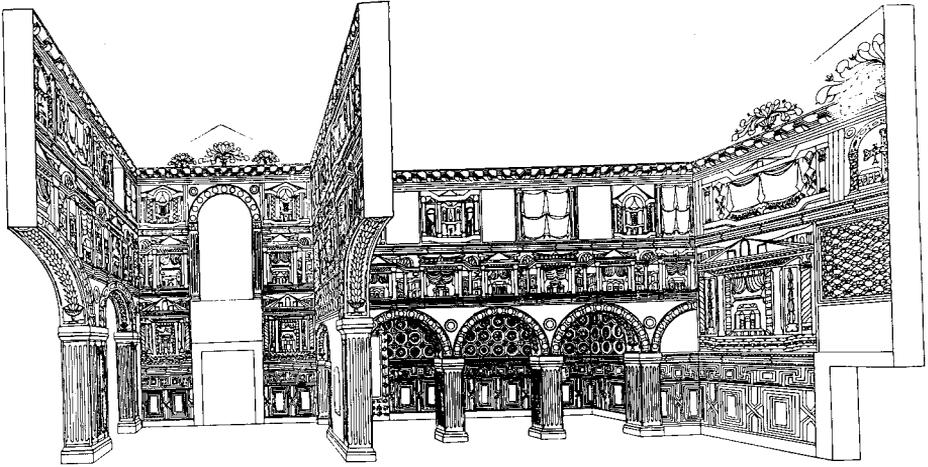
Santullano. Sección longitudinal de las naves central y transversal, con el esquema de las pinturas.
